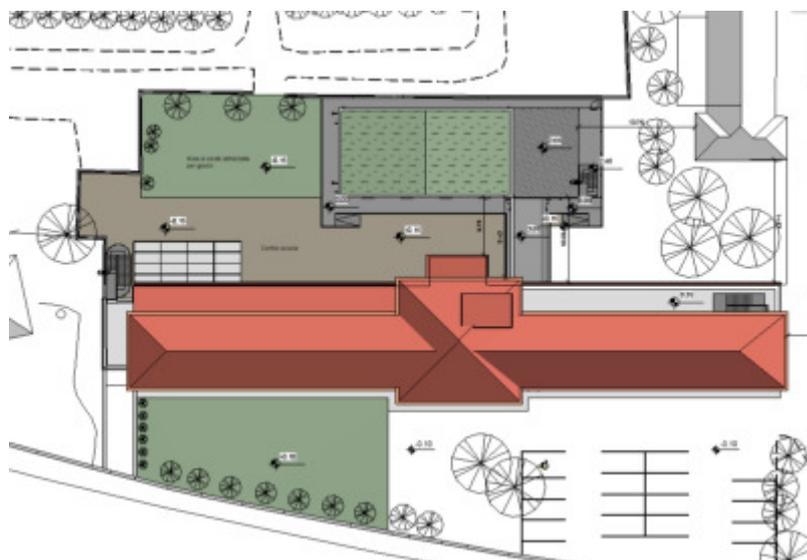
Planimetrie sistemazione esterna – stato di progetto
